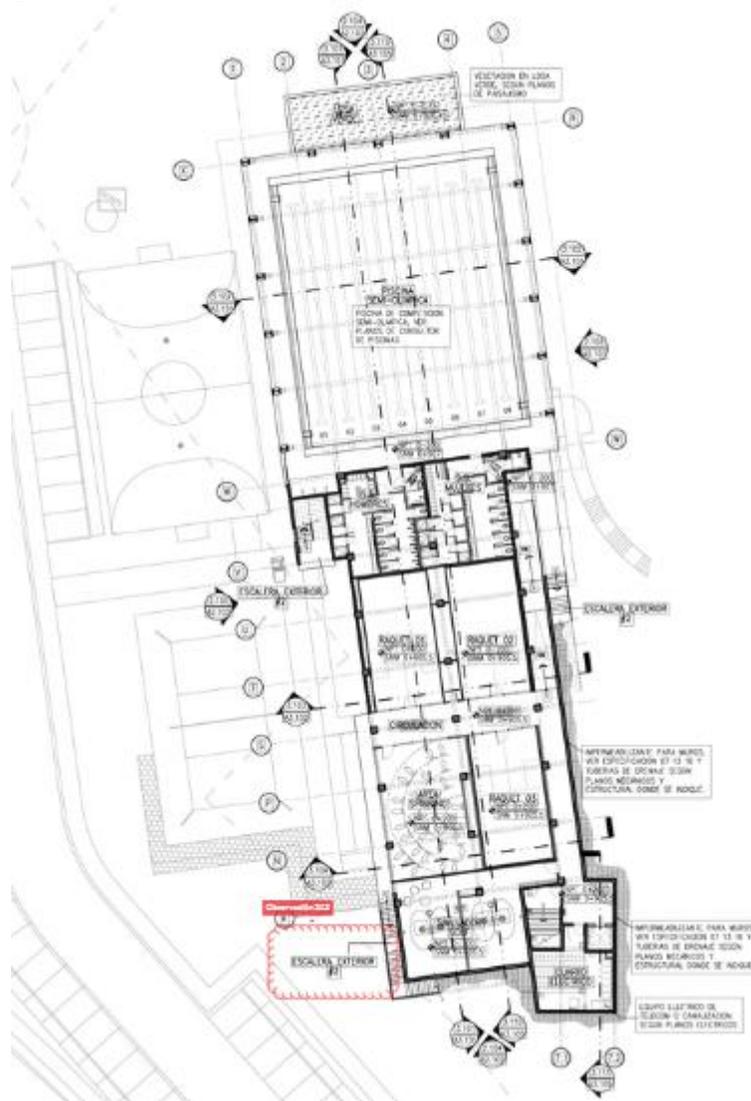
Planta arquitectónica módulo A, nivel 907 (-200). Fuente: EDIFICAR, 2018.
